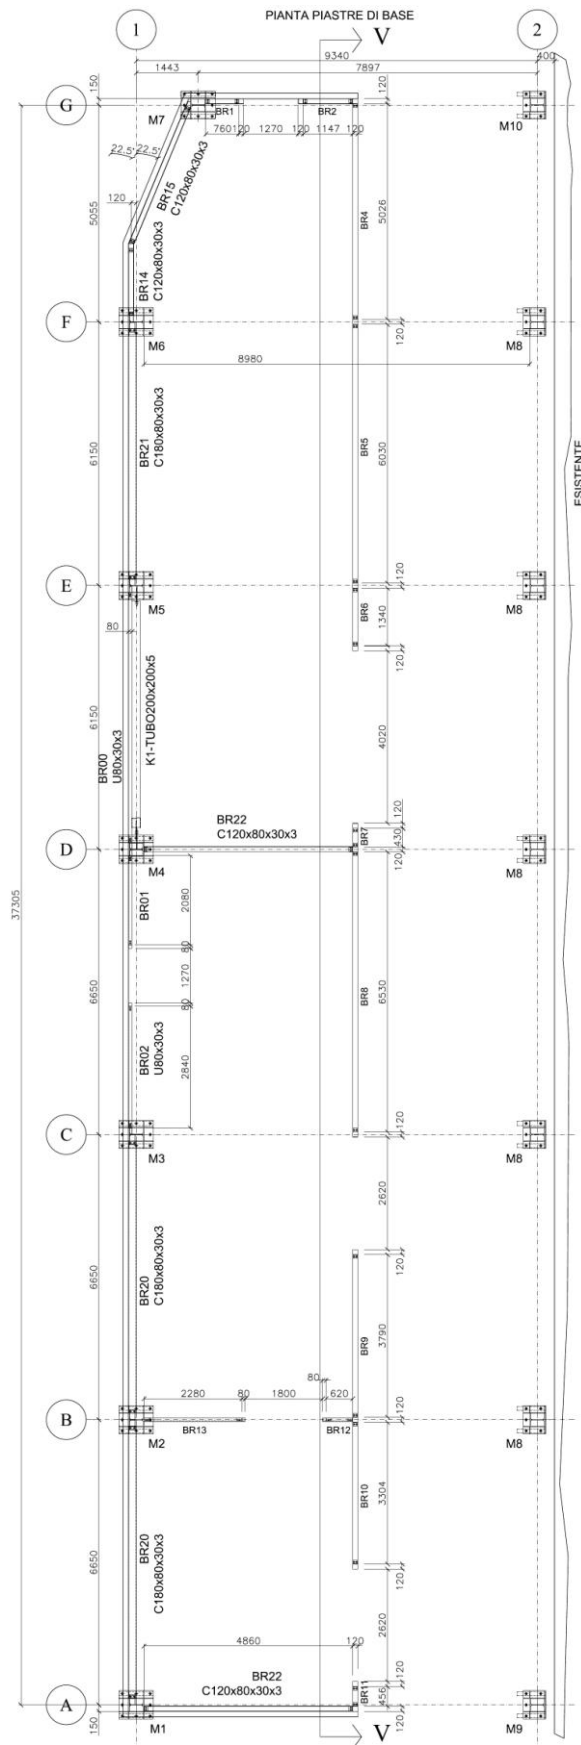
Particolare di A.2006.a.us.T03 - Piante - Pianta piano terra
